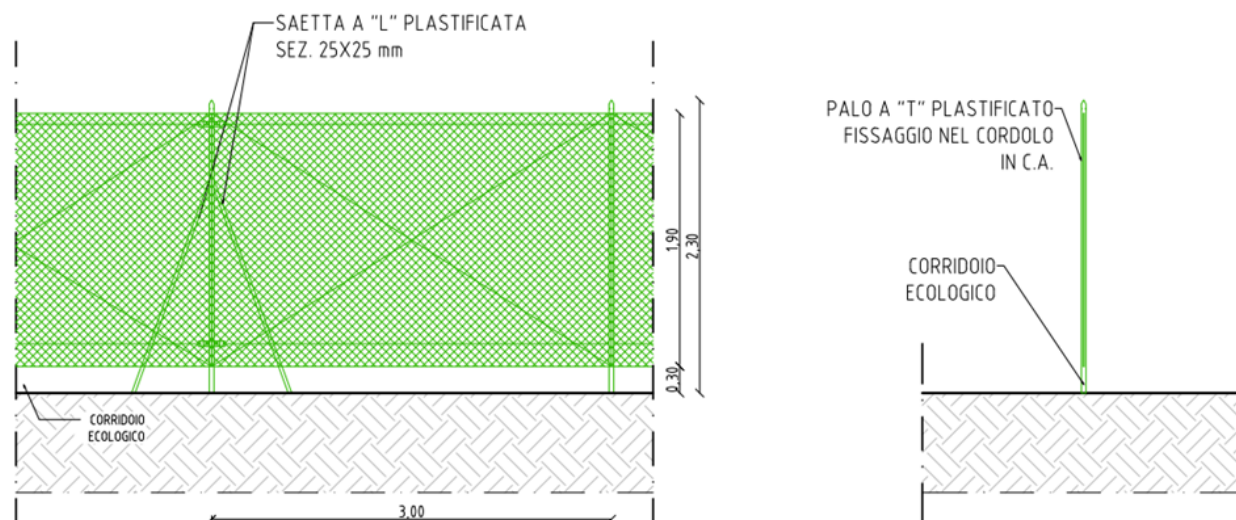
Dettaglio recinzione - Prospetto e sezione
